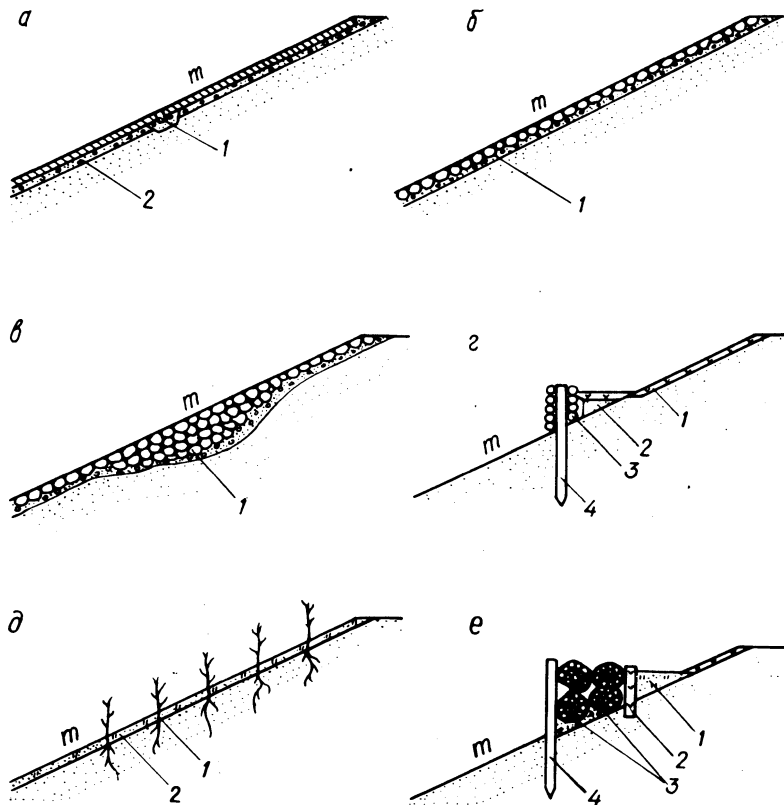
Типы креплений откосов земляных плотин и берегов на водохранилищах БССР: а - железобетонные монолитные и сборно-монолитные плиты (1 - деформационный шов; 2 - железобетон); б - каменное мощение (1 - камень (мощение)); в - каменная наброска (1 - камень); г - плетневое (1 - посев трав; 2 - грунт; 3 - плетень; 4 - колья); д - древесно-растительные насаждения (1 - ивовые хлысты; 2 - растительный грунт).
